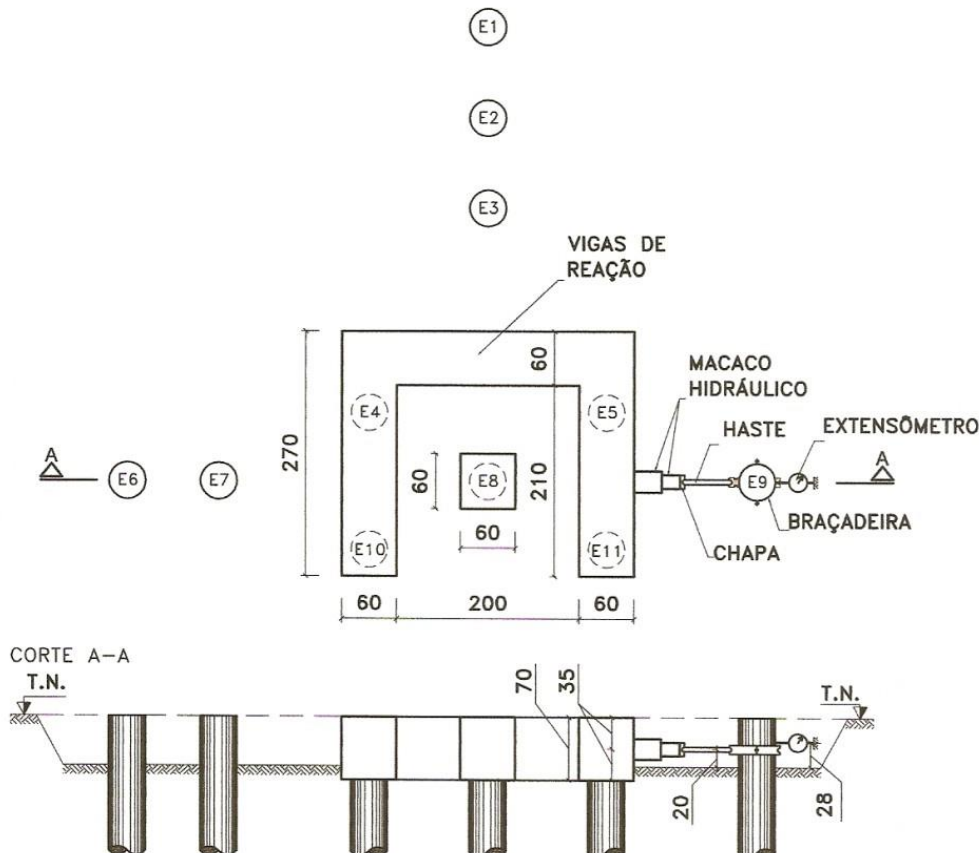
Planta baixa e corte do esquema de reação e disposição das estacas submetidas às provas de carregamento horizontal no topo (cotas em centímetros).
